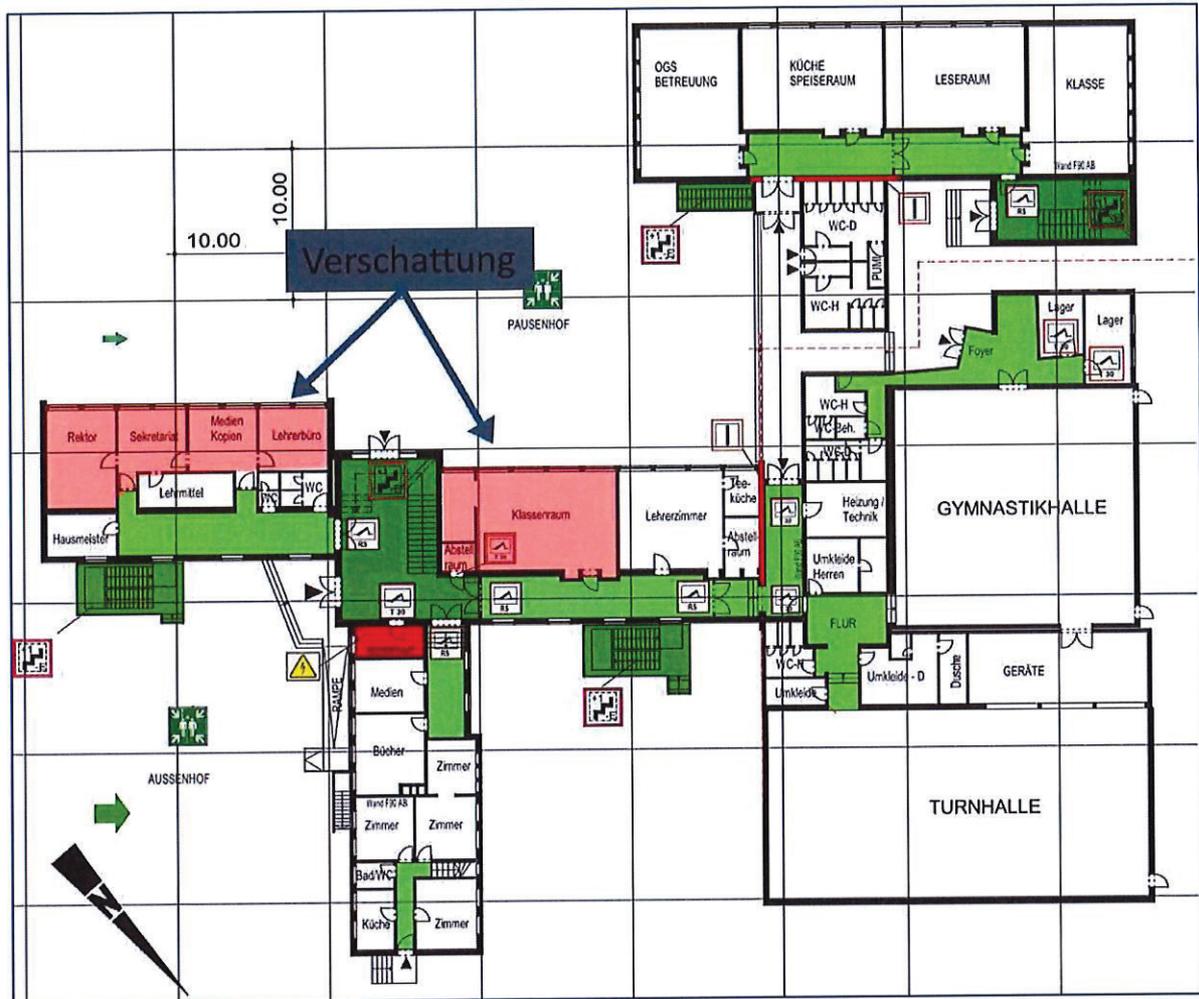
Grundriss Erdgeschoss; Die Räume mit geplanter Verschattung sind rot markiert
